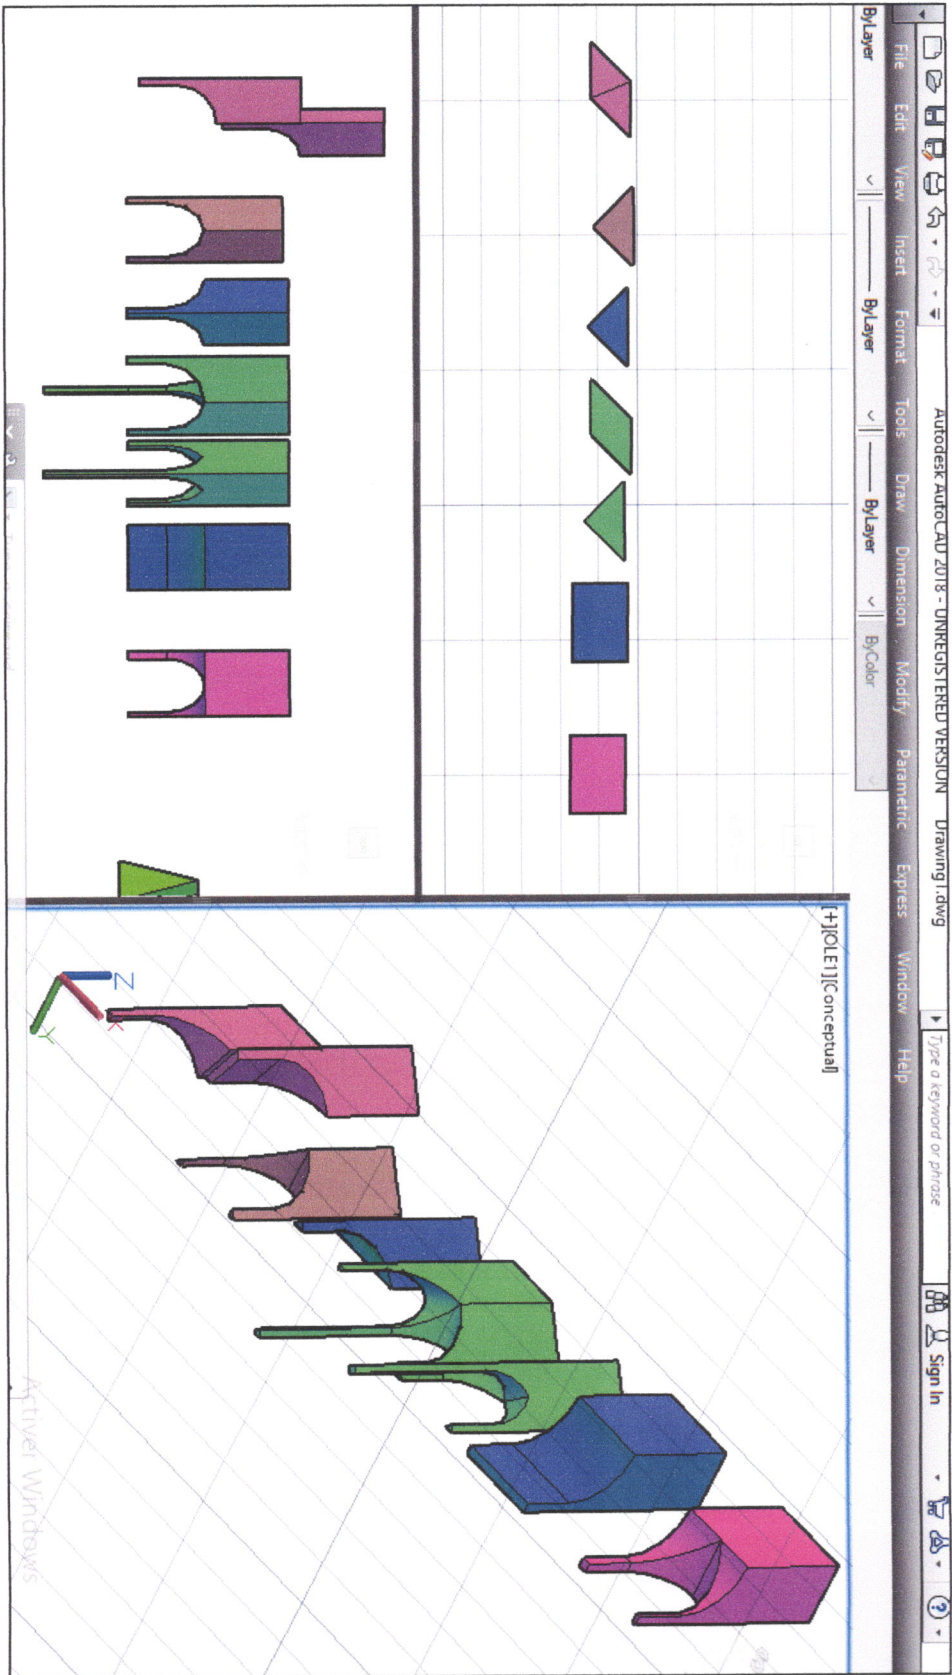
a/ Principe du Design de quelques pièces de Mouqarnas projection et 3d basé sur le triangle isocèle avec les distances unitaires de ses cotés et de sa base dessin de l'auteur
